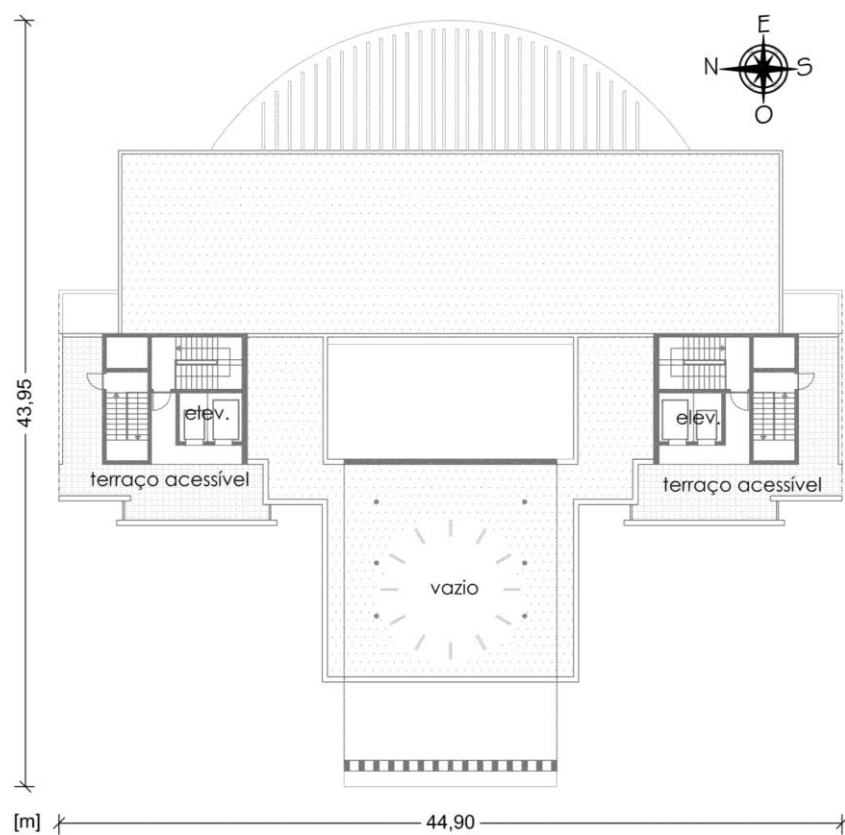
Planta Arquitetónica do Piso 2: corpo E (s/escala).
